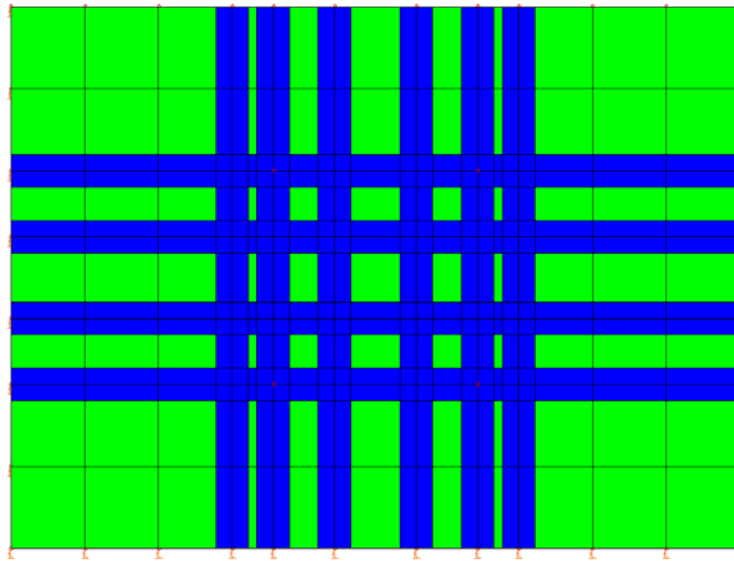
Vista in Pianta Platea e Travi di Fondazione
